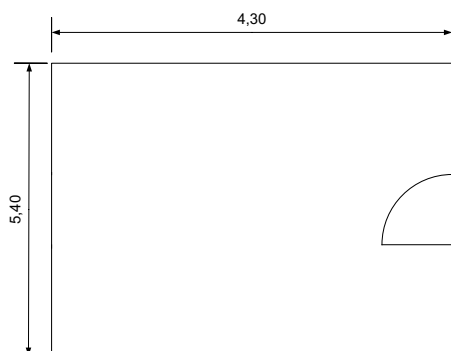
Grundriss Besprechungsraum
